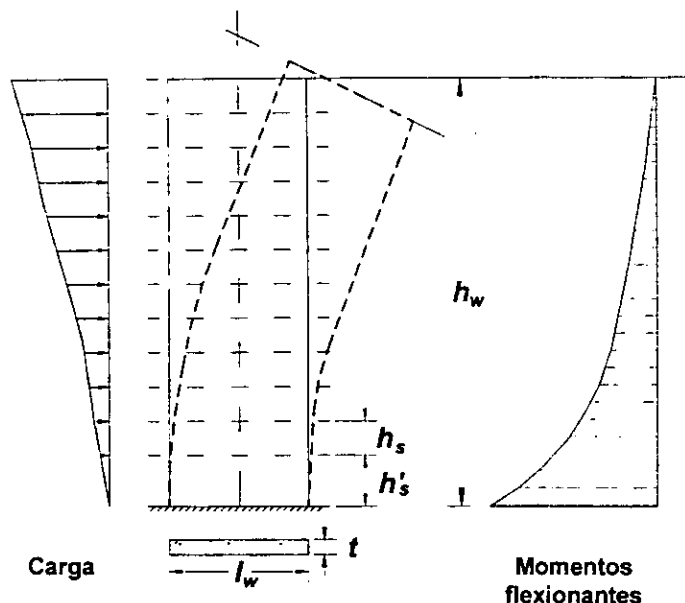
Muro estructural en voladizo [Park y Paulay, 1975]
